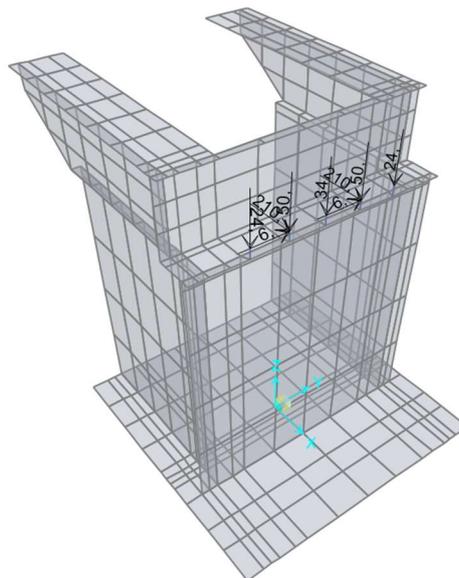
Modello FEM Finale – Vista assometrica carichi da frenamento da impalcato kN su spalla fissa (imp_fren)
